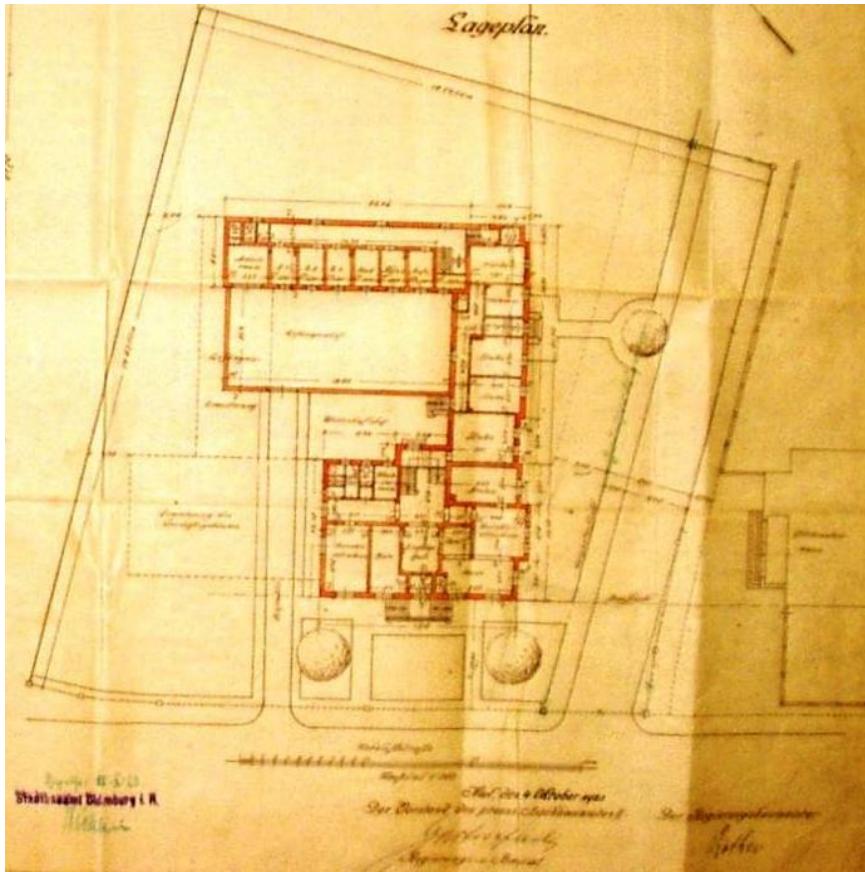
Lageplan. Das Gebäude befindet sich auf einem Grundstück von 4.500 Quadratmetern.
